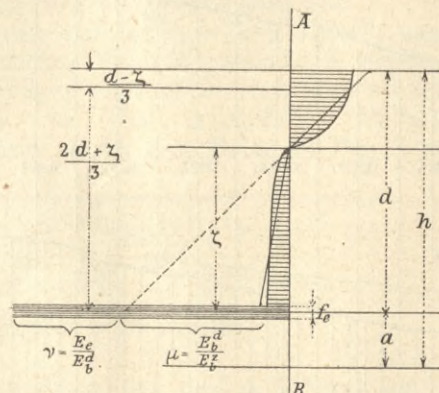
Spannungen in einer armierten Betonplatte im Stadium II.
